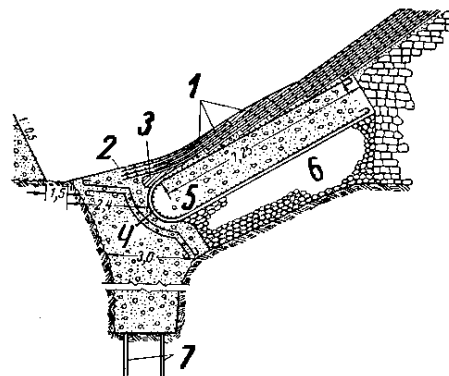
Шарнирное соединение железобетонного экрана плотины Cogswell с зубом
